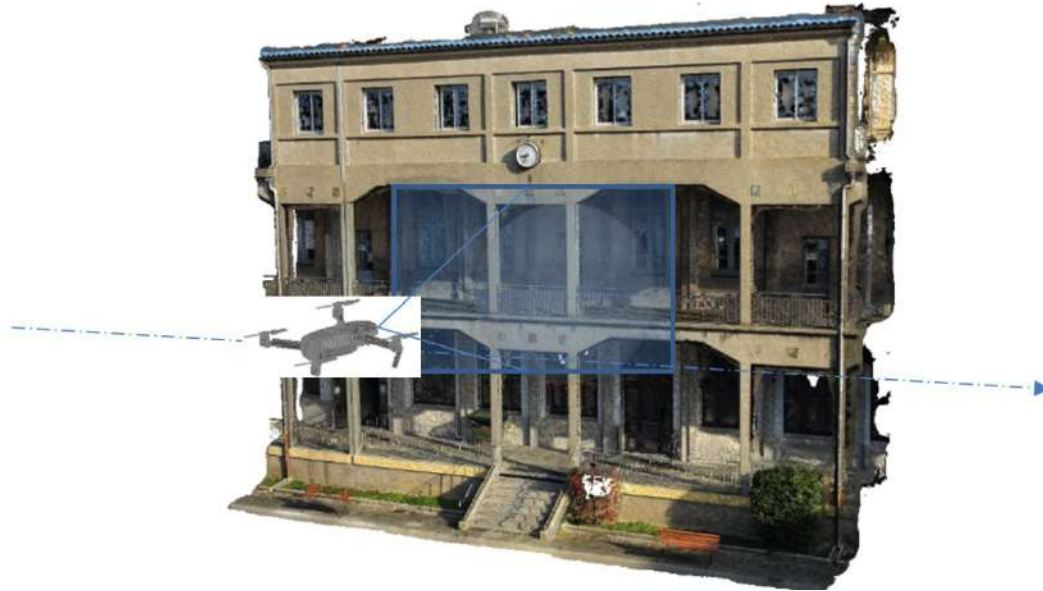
Photos d'un bâtiment pour l'étude de la façade
